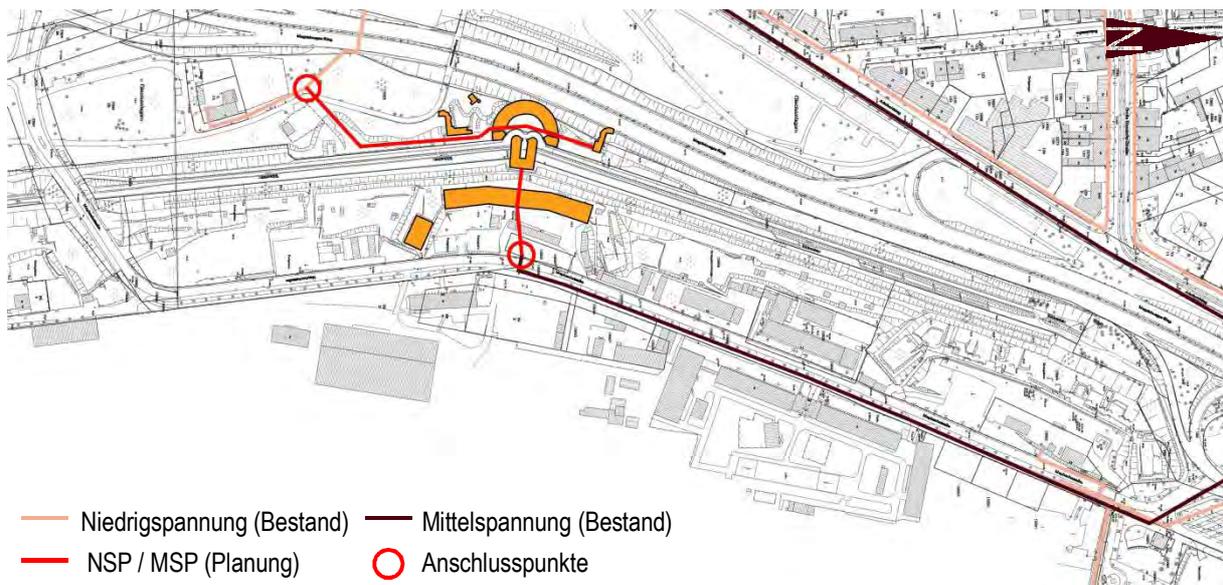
Kartierte Stromleitungen Gebäudeanschlüsse (Bestand und Planung)
